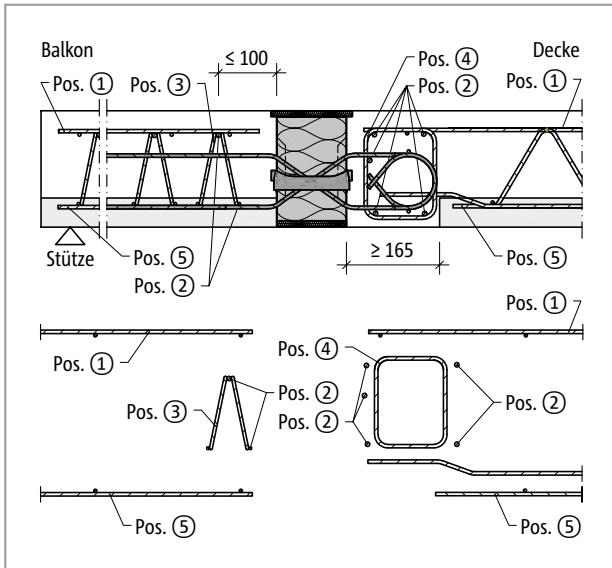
Schöck Isokorb® XT Typ Q-VV1 bis VV4 Bauseitige Bewehrung mit Gitterträger
